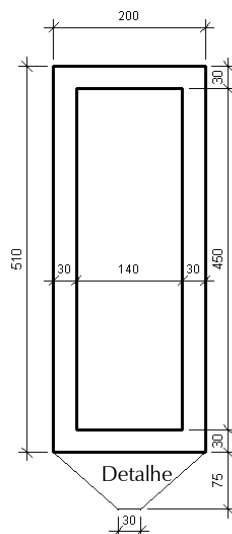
Vista em planta do Aqueduto Tigre
